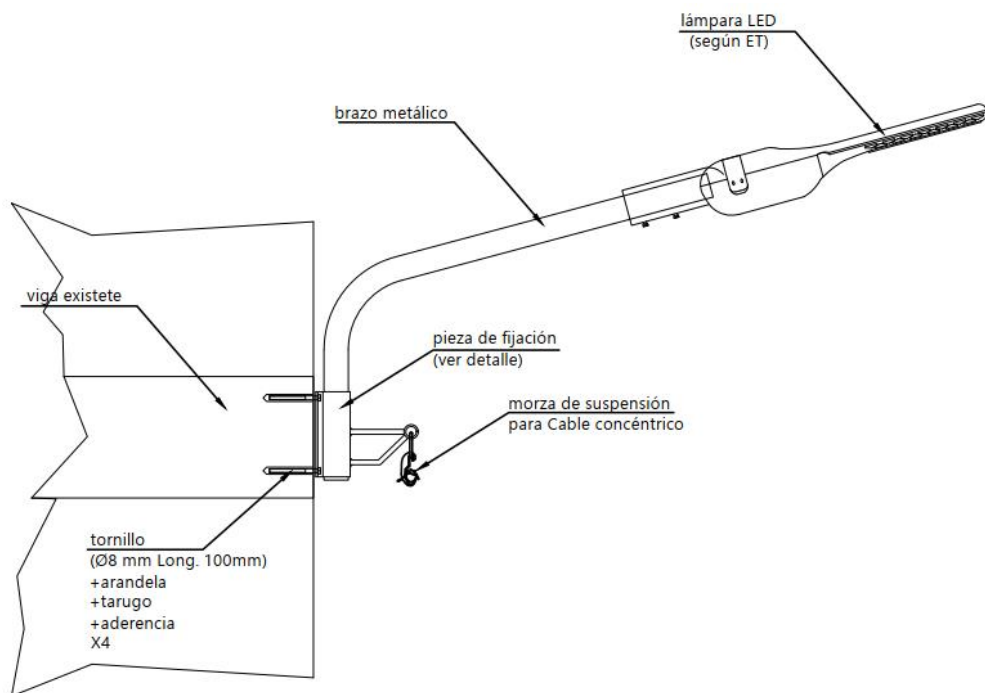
Esquema de instalación de brazo metálico y luminaria sobre viga de H°A° o muro.
